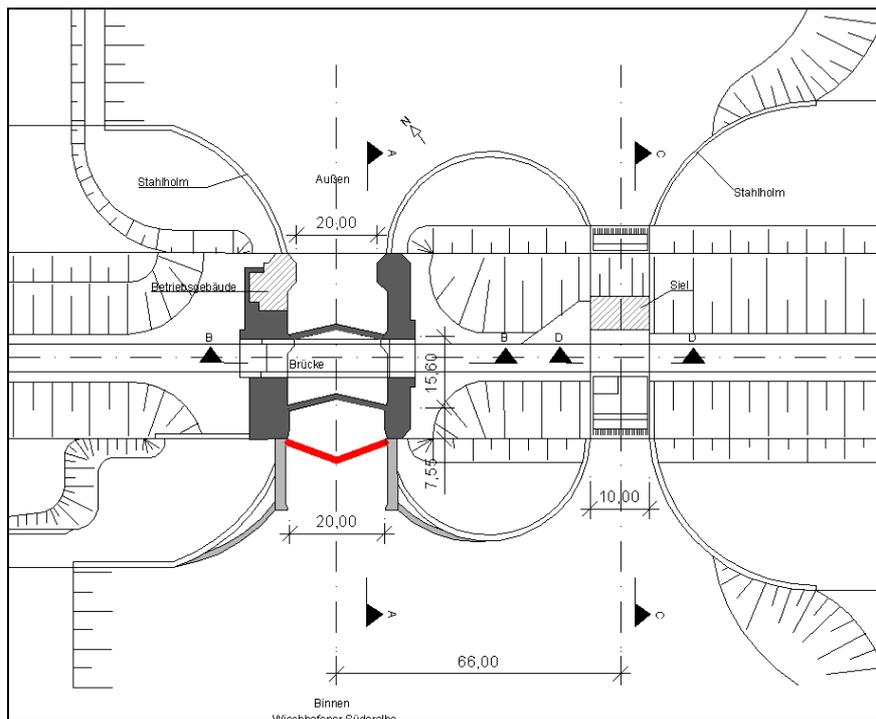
Stemmtor Grundriss Wischhafener Sperrwerk
